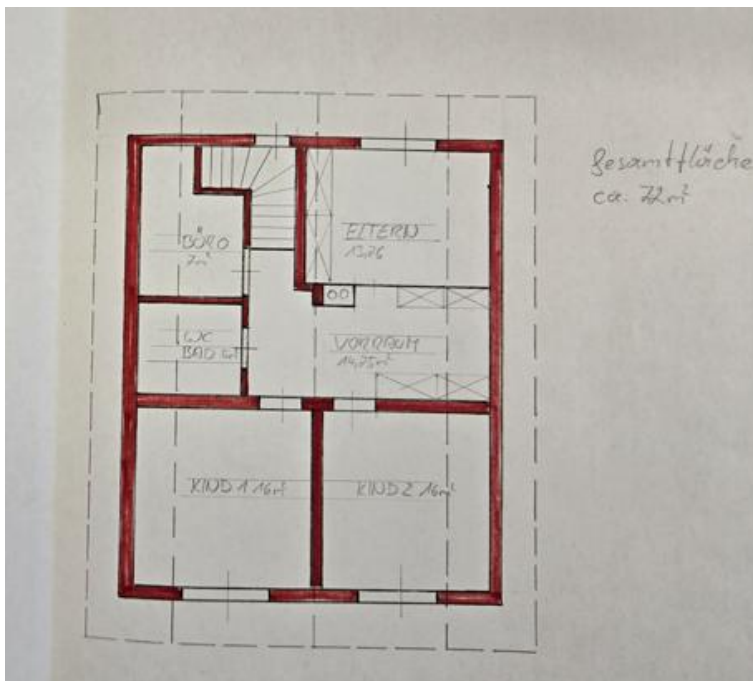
Geplante Wohnraumerweiterung im Dachgeschoß
